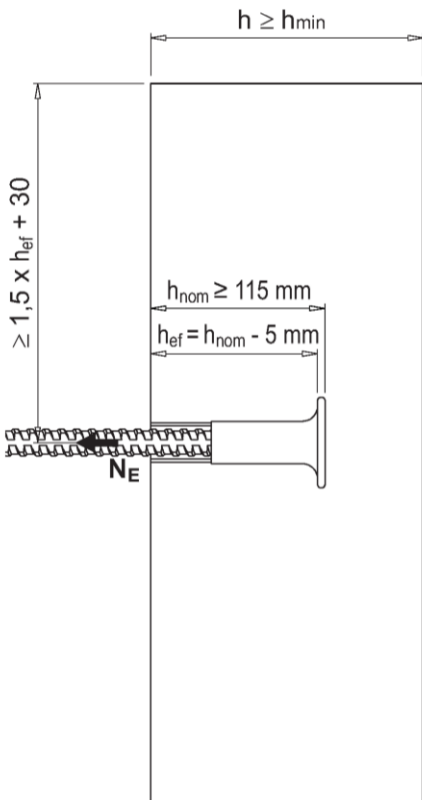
Einbauzustand Gesimsanker mit Ankerstabstahl (DOKA-Ankerstab 15,0mm nach Z-12.5-96) bei reiner Zugbeanspruchung
